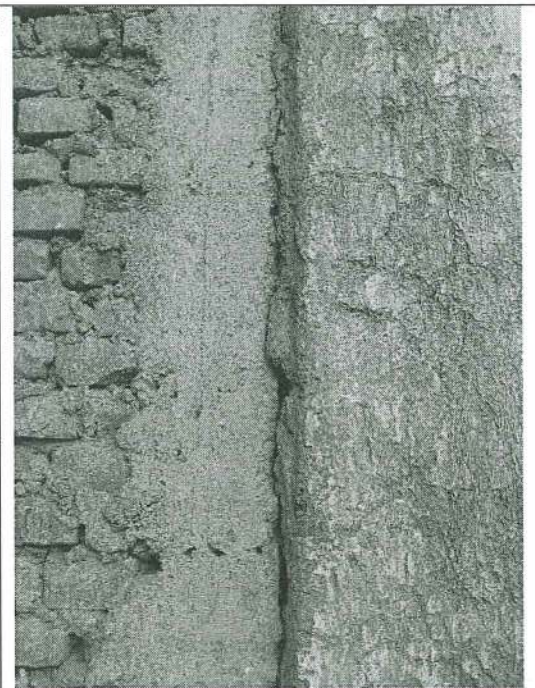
Encuentro de muros en la parte exterior de la fachada sin tarrajeo
